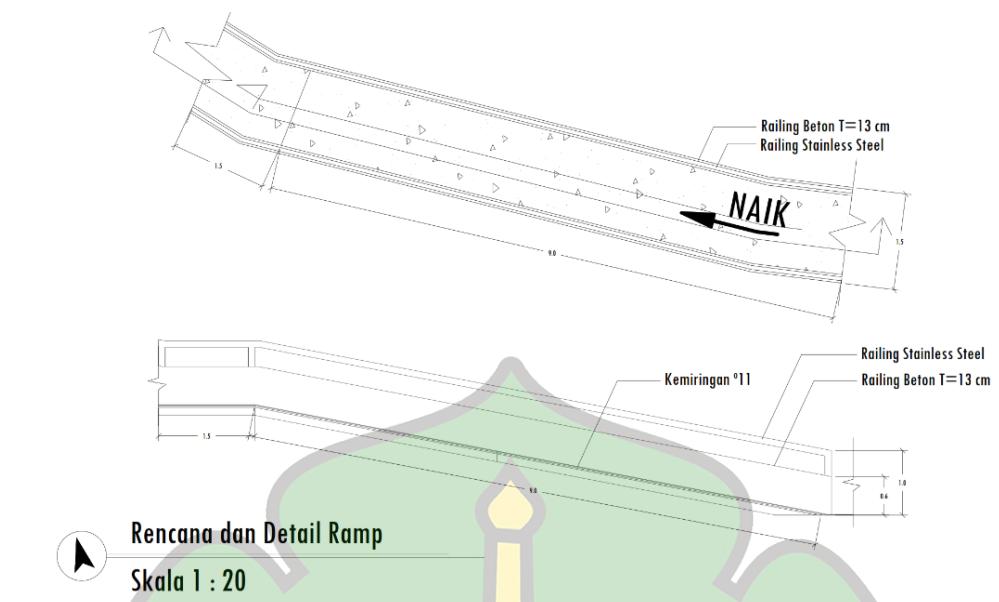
Rencana Tangga dan Ramp *Convention Hall Lt. 1
